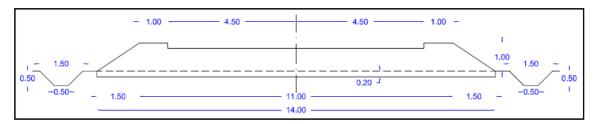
Schema sezione trasversale, prolungamento via F. Enriques
